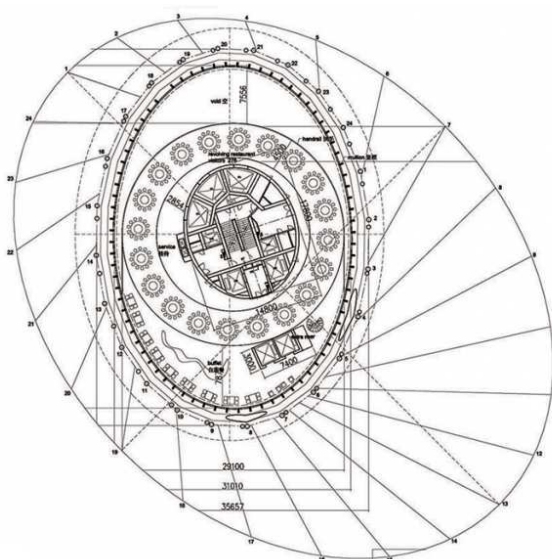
a i b Żelbetowy trzon wieży Canton Tower w Chinach
